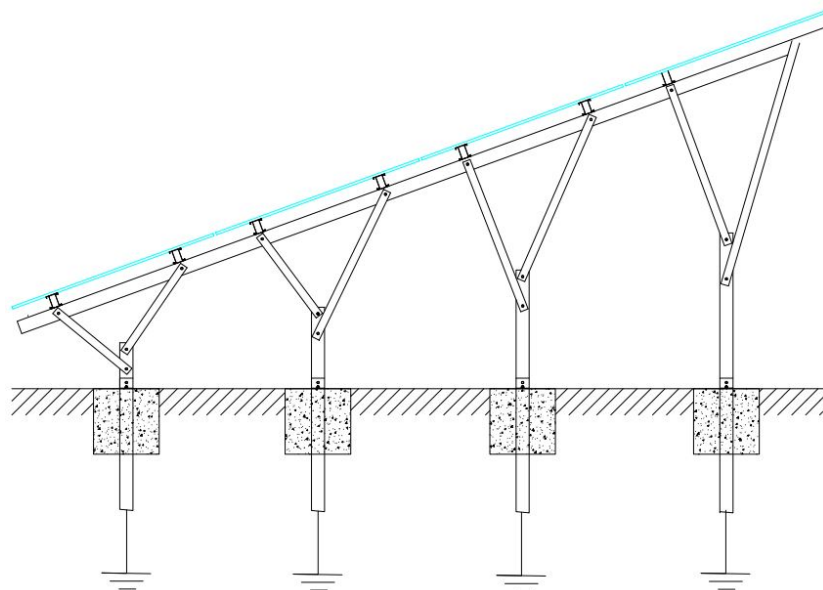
Estructura metálica de un sistema fotovoltaico instalado en el suelo.
